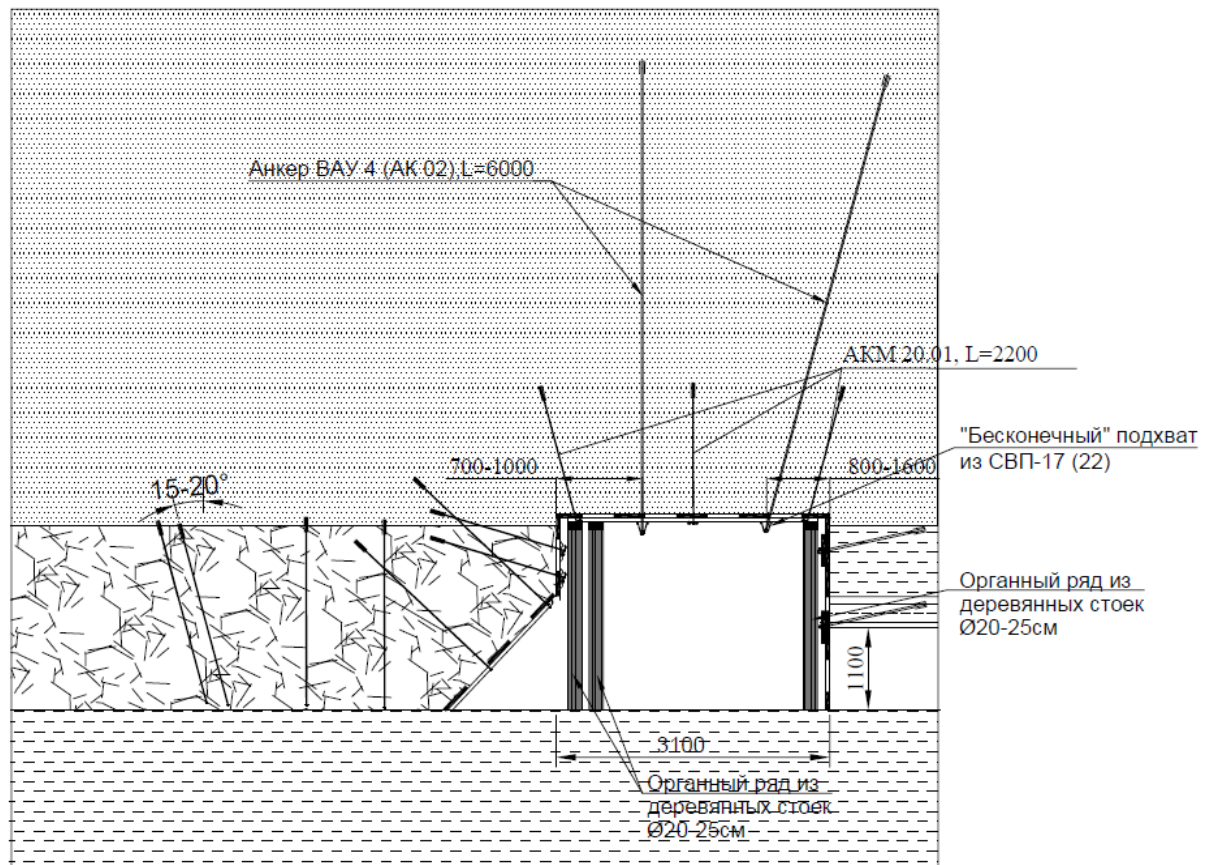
Обрушение кровли и сохранение монтажной камеры после прохождения комплекса (МК 410)
